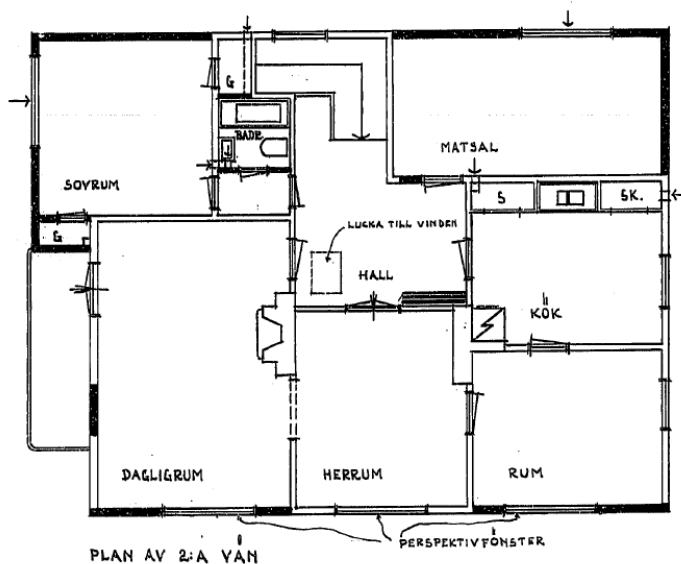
Planlösning övre plan enligt ritning ombyggnad från 1947.
